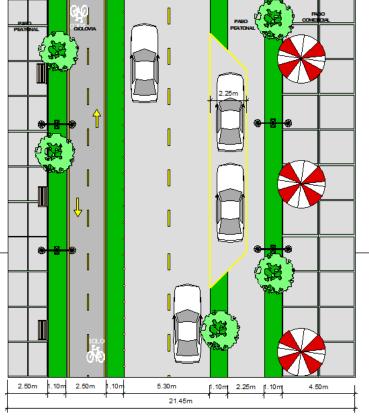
PLANTA GABARITO PROPUESTA CORREDOR COMERCIAL LA 15
